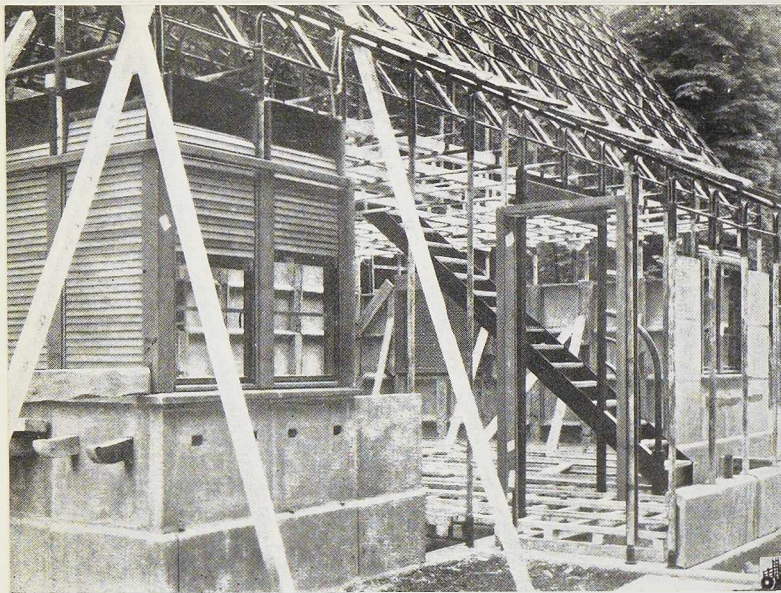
L'escalier fabriqué en usine, facilite les travaux; il est utilisable dès sa mise en place.
